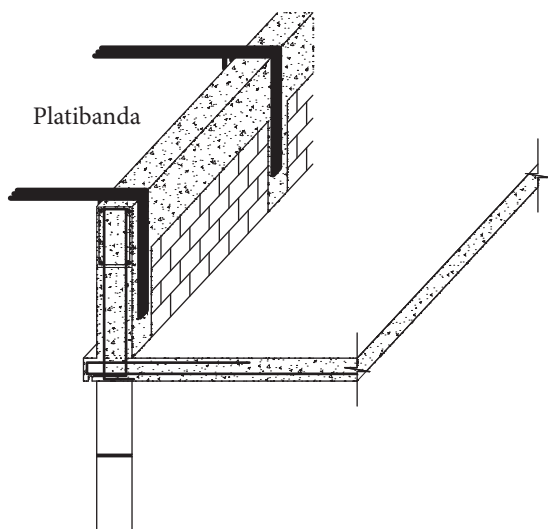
Balancim apoiando platibanda de pilares e viga de concreto armado engastados em laje maciça moldada no local.
